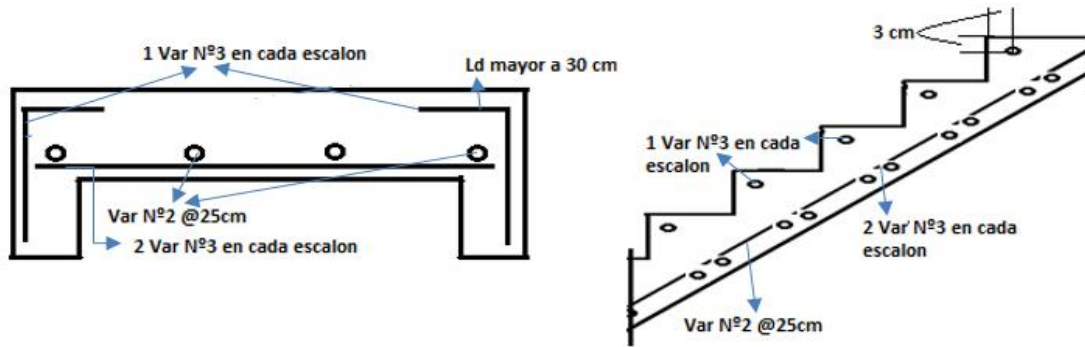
Esquema de armado de escaleras apoyadas transversalmente
